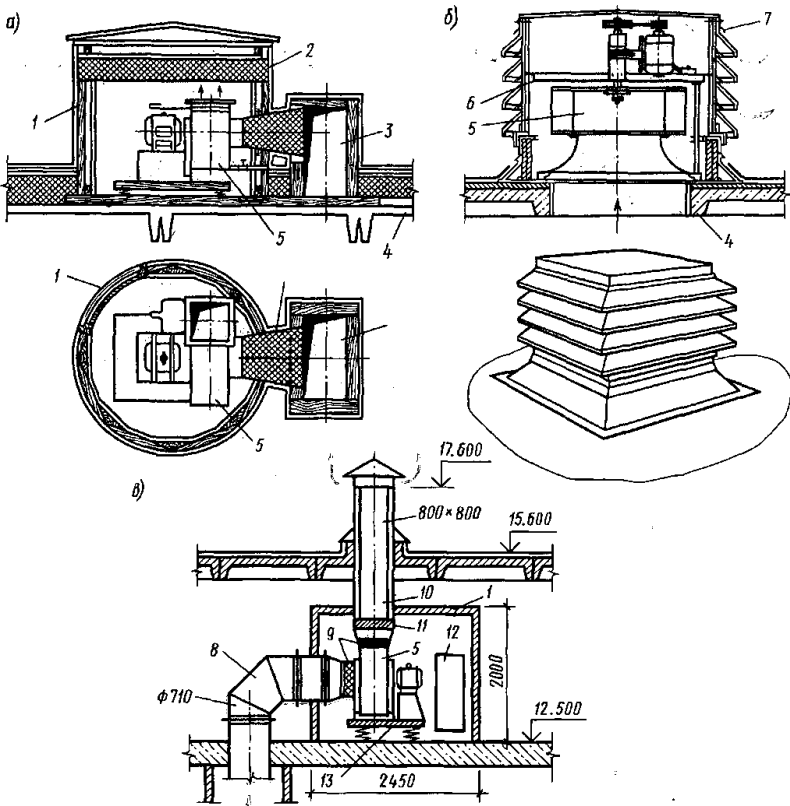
Камеры вытяжных механических систем: *а* – камера-шахта с центробежным вентилятором, смонтированная на крыше; *б* – то же, с крышным вентилятором; *в* – вытяжная камера на чердаке; 1 – стенка камеры; 2 – сетка или решетка; 3 – утепленный короб; 4 – железобетонная плита перекрытия; 5 – вентагрегат; 6 – опора под вентилятор; 7 – штампованный металлический корпус с козырьком; 8 – воздухопровод; 9 – гибкие вставки; 10 – шахта с зонтом; 11 – утепленный многостворчатый клапан; 12 – входная дверь; 13 – пружинные амортизаторы
